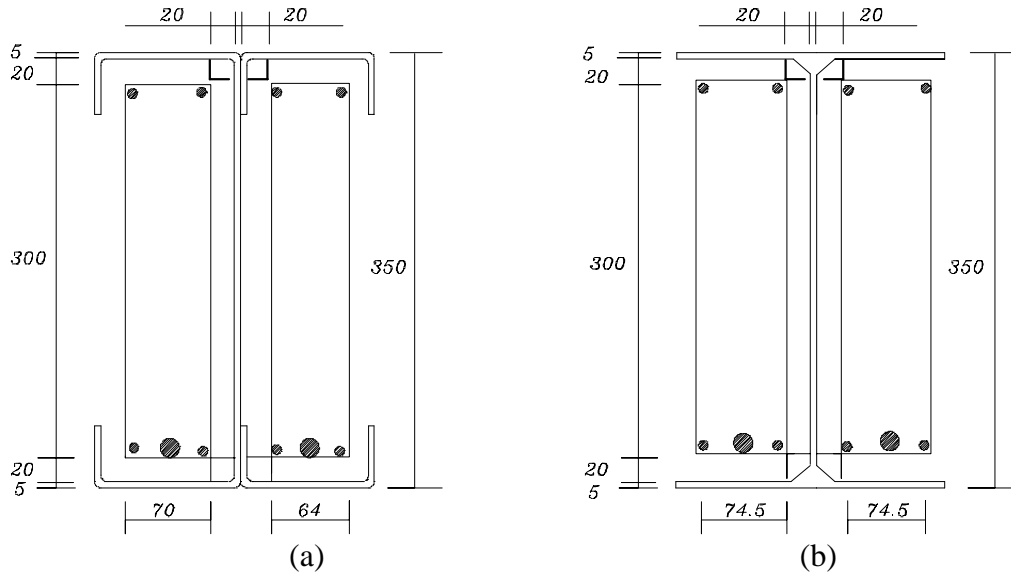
Posicionamento dos Estribos da Viga VD2 (a) e das Vigas VS1 e VS2 (b)
